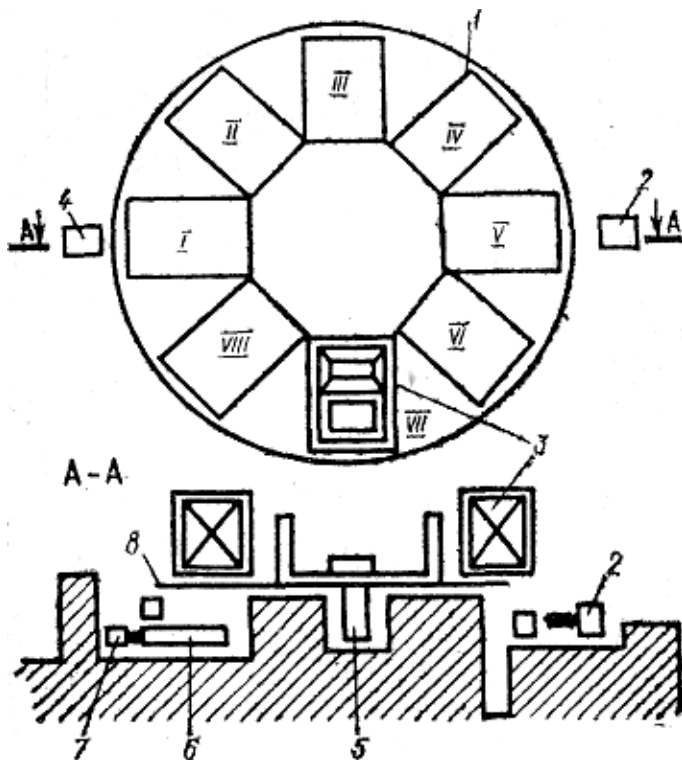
Схема карусельної установки для виготовлення об'ємних елементів:
